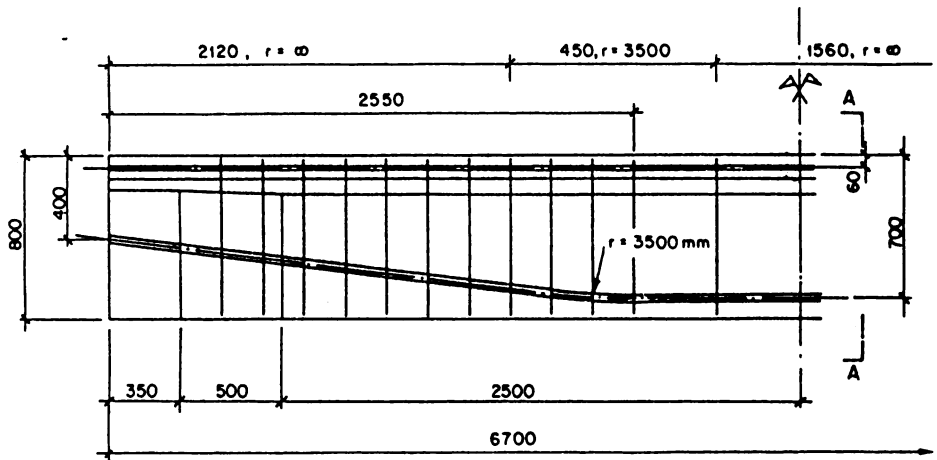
Balkenabmessungen, schlaffe Bewehrung, Vorspanndetails
